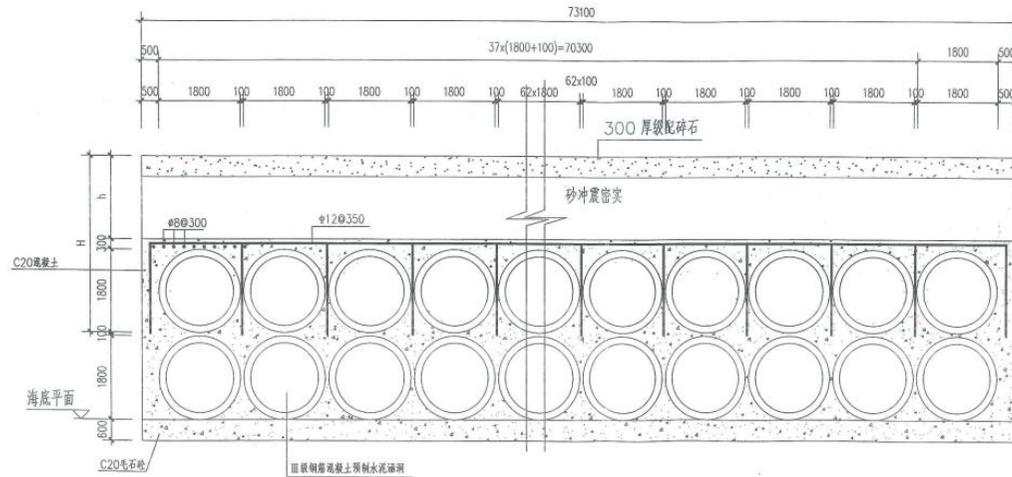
本项目非透水构筑物——双涵洞直立式路基段典型立面图
